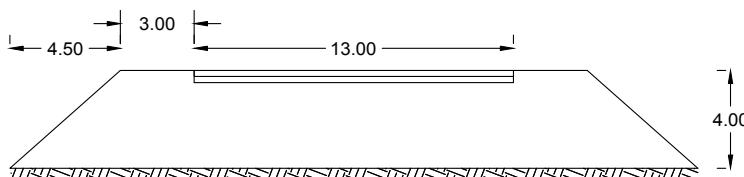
2 Cross Section Timbunan Jalan STA 6+000
